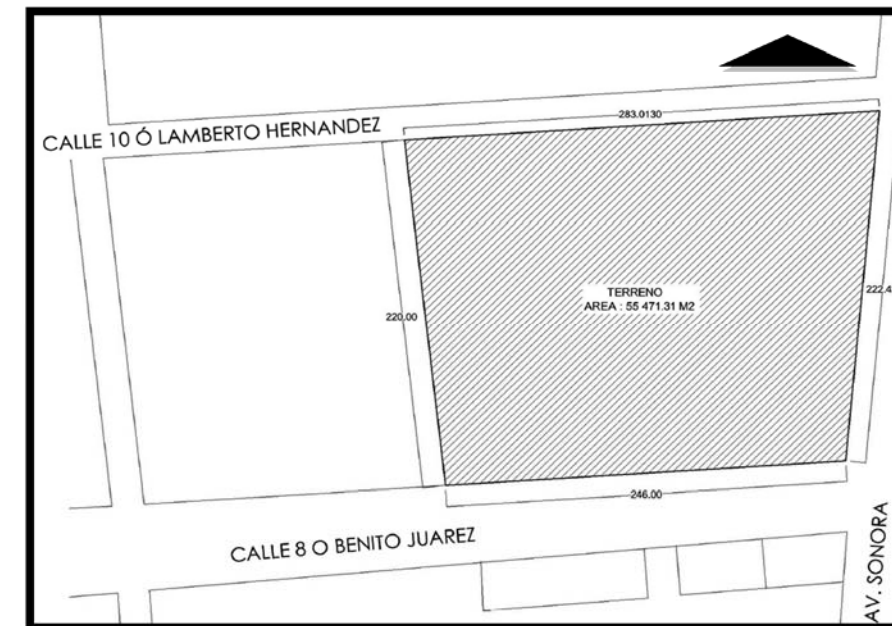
Dibujo del terreno acotado. Fuente: Archivo propio S/E.
